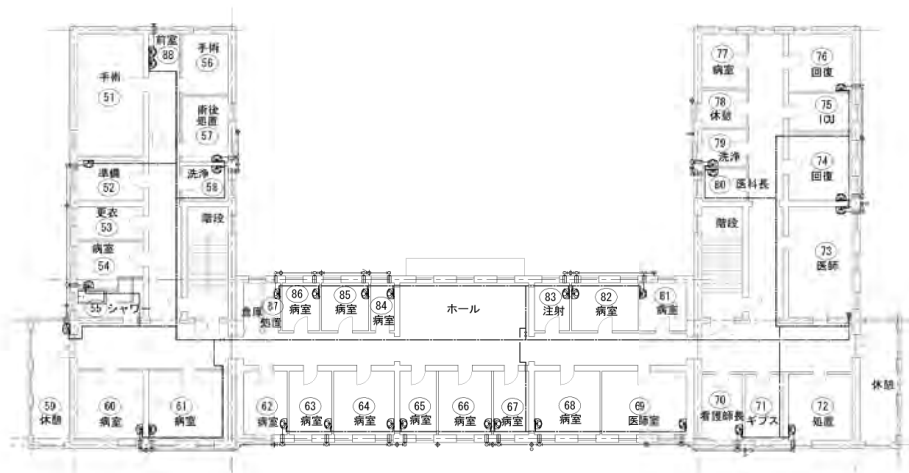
ショミ郡中央病院 小児科棟 2F平面図 / 給排水計画図 1/300
